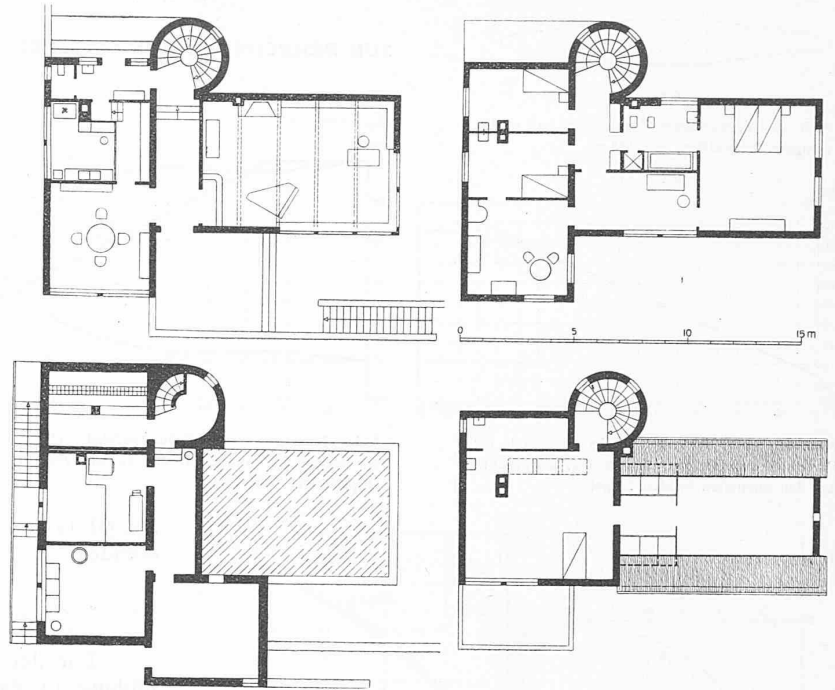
Haus B. Séquin in Zürich. — Grundrisse 1 : 300.
